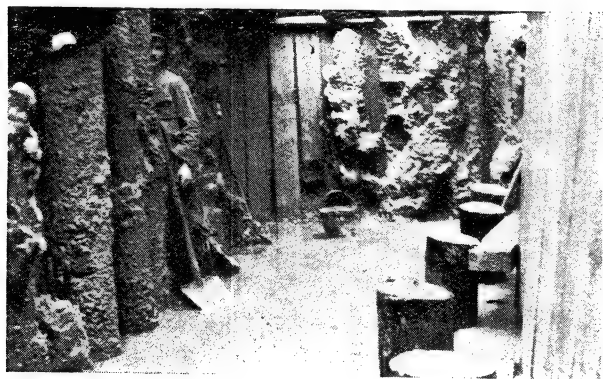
Barajul Bilciurești. Capetele piloților de beton armat executați după metoda injecțiunilor.
